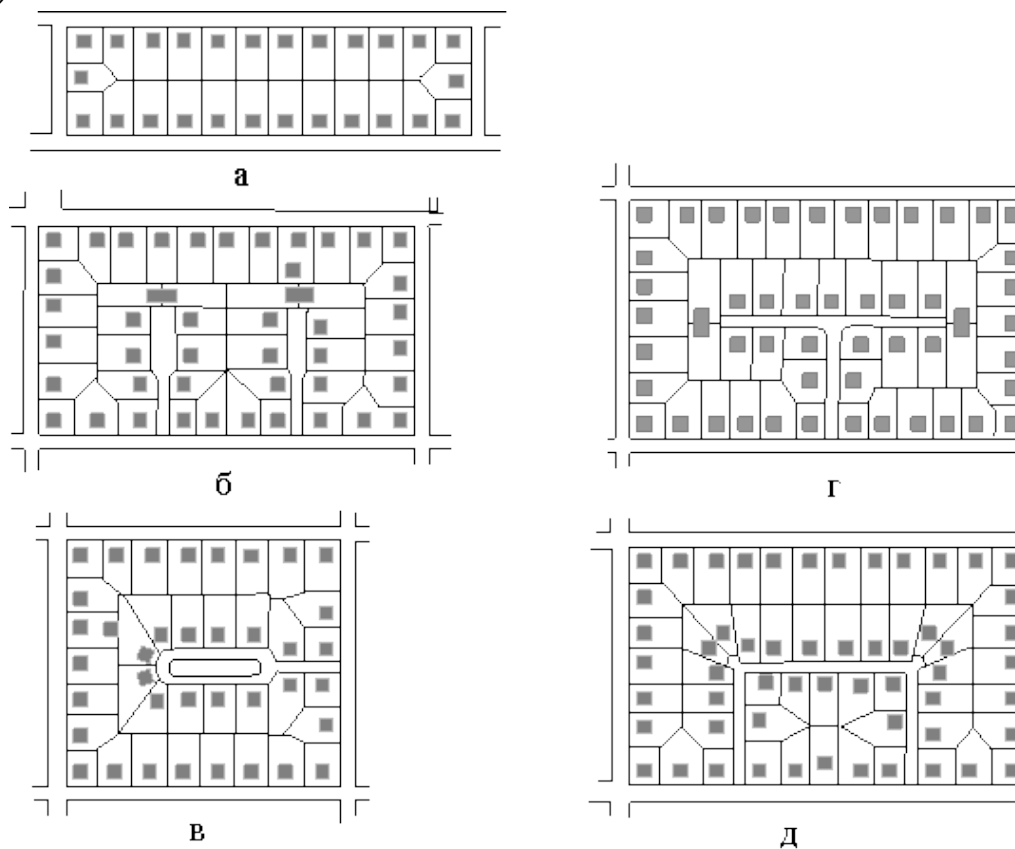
Схемы планировки кварталов: а – усадебные дома уплотненной застройки; б, г - с тупиковым проездом; в, д – с петельным проездом
